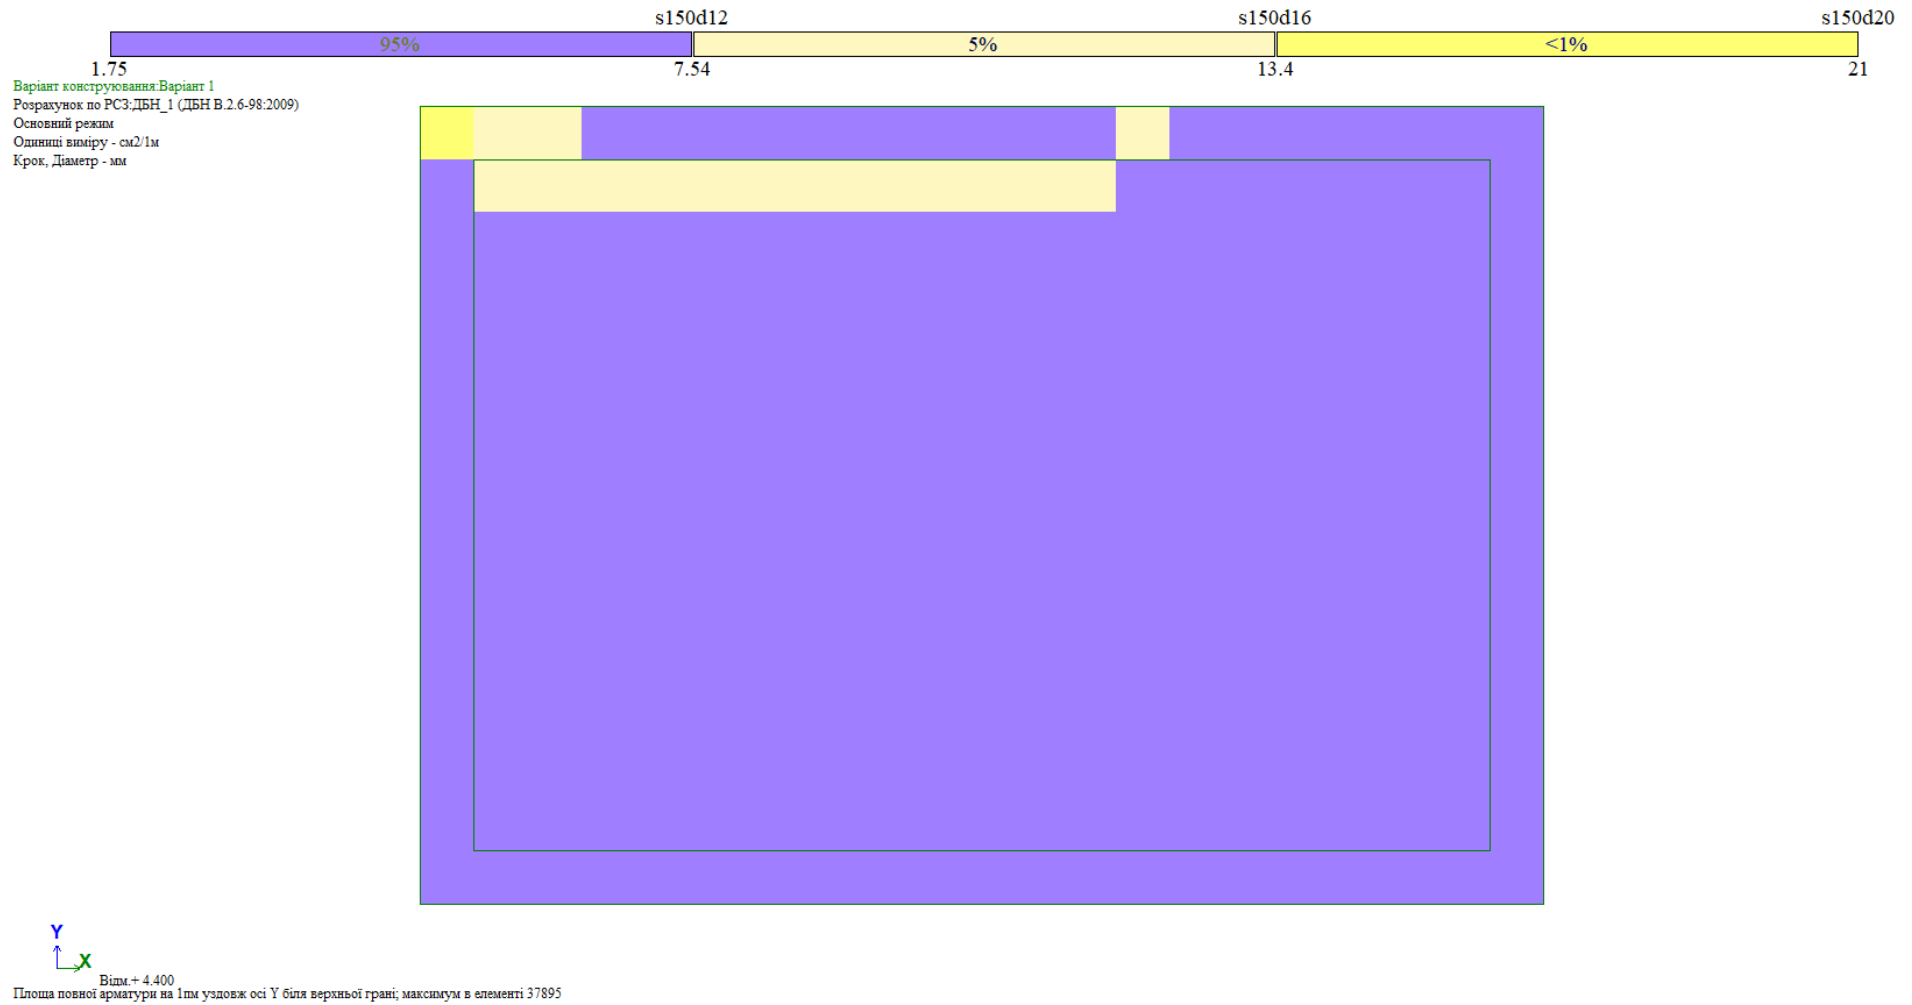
Армвання верхньої зони вздовж осі Y (см²/1м) плити покриття над входом в сховище
